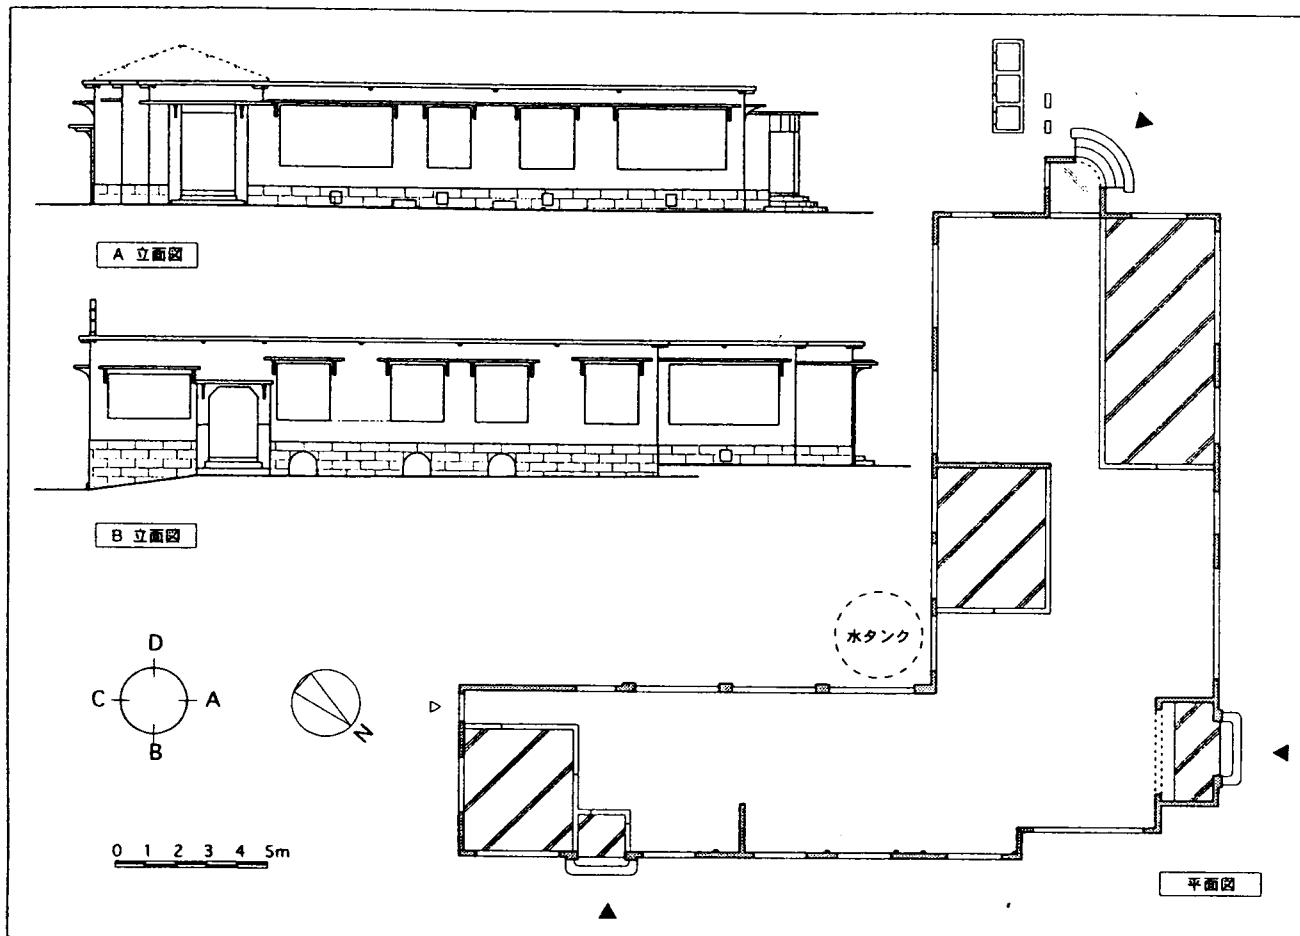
旧南洋興発ロタ製糖所附属医院の現況平面図と立面図
